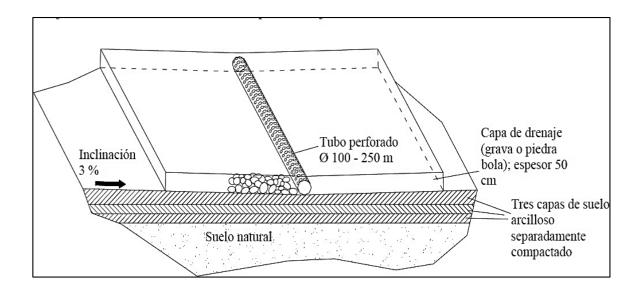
El tubo perforado dentro de la capa de drenaje
